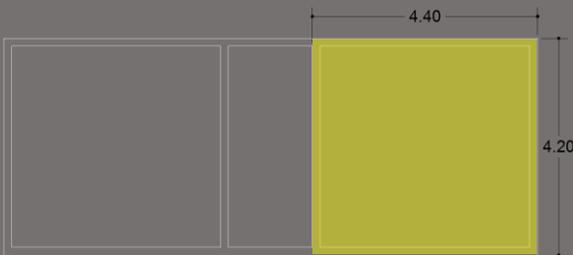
Planta de Sanitarios para cálculo de zapata corrida.
